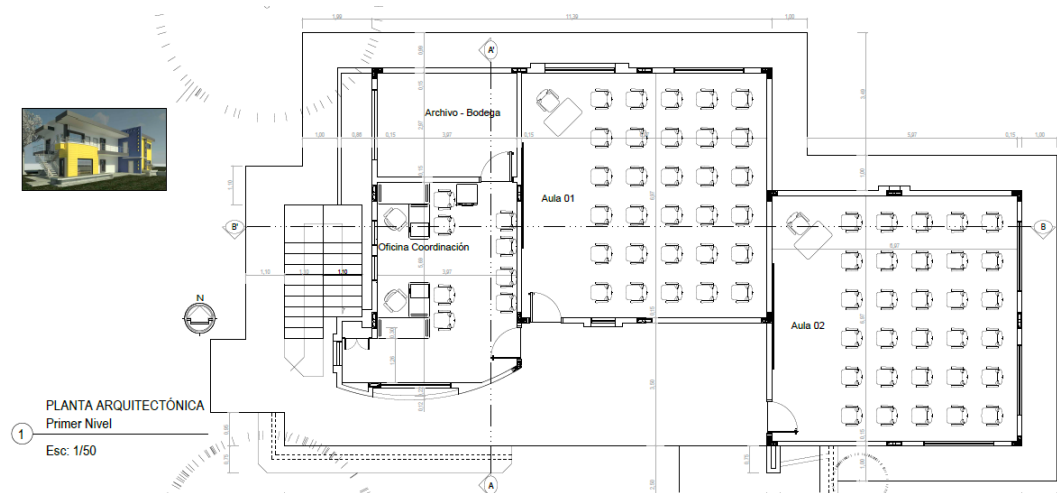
Planta Arquitectónica 1 Primer Piso Actual Cafamaz.
